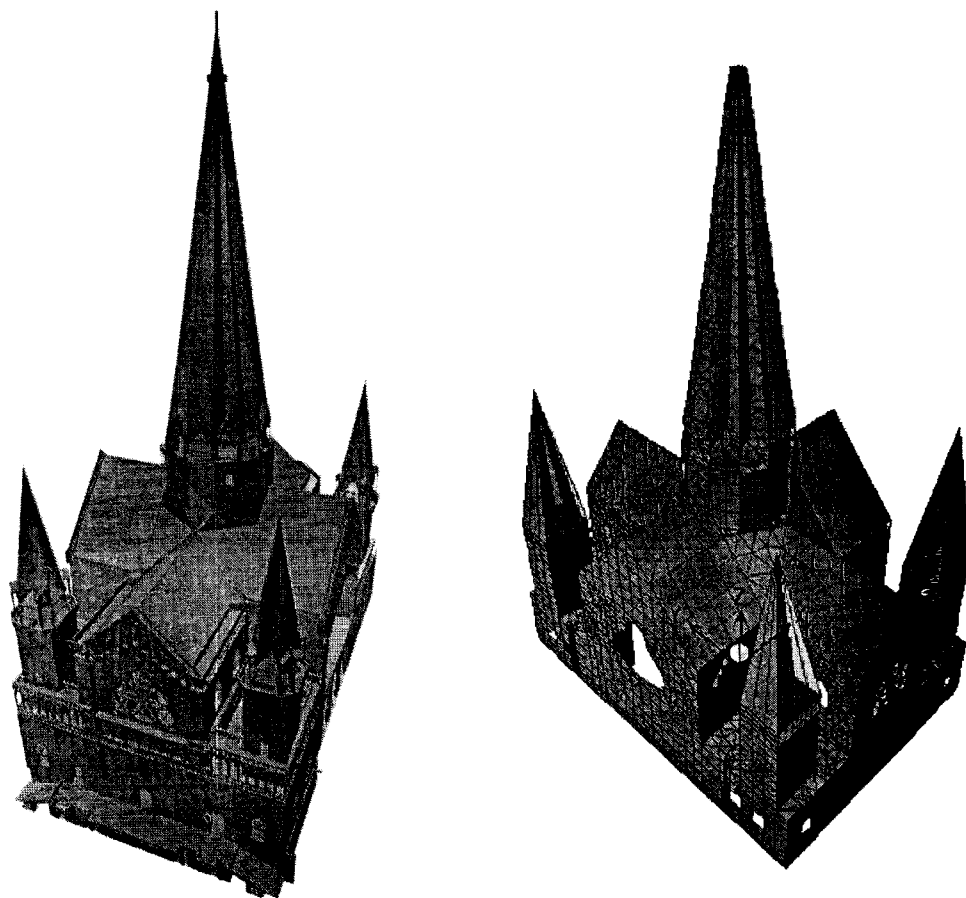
Vista isométrica levantamiento estructural y del modelo en elementos finitos
